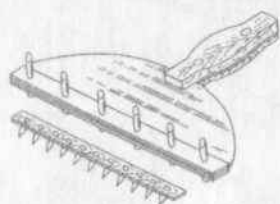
Шкребок для створення борозен у пластичному шарі штукатурки
